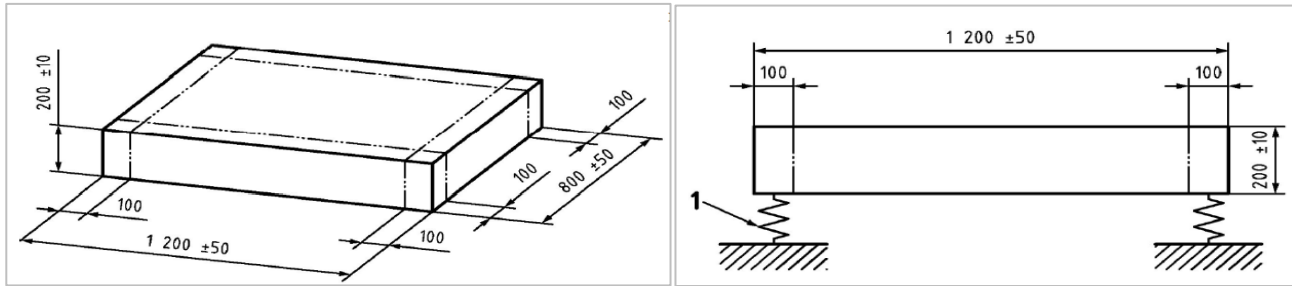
Dimensiones de la losa de hormigón a utilizar (izquierda), e indicación de la necesidad de colocar unos soportes elásticos bajo ésta (derecha)
